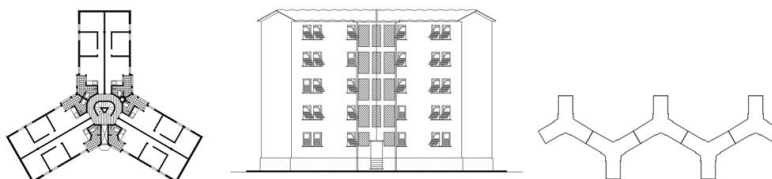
Areal, 1944 - IAPI - Rio de Janeiro, RJ. 600 unidades, blocos. Respectivamente planta Baixa fachada e esquema de agrupamento.
